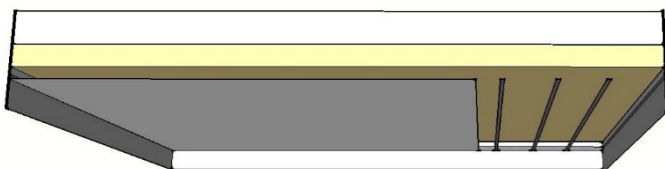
Plafond constitué de montants simples ou doubles sans dispositif de suspension au support
